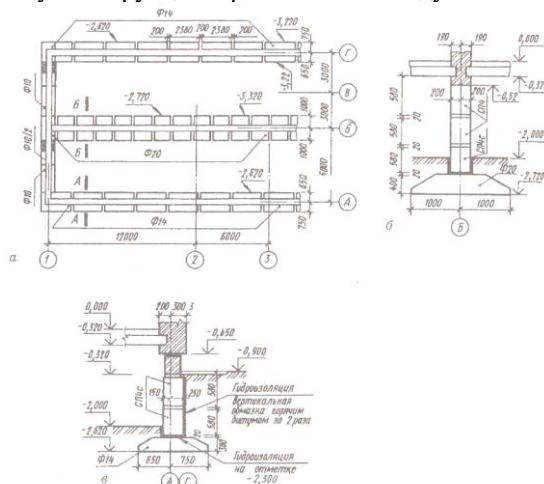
Фрагменты расположения сборных железобетонных элементов ленточного и столбчатого фундаментов
